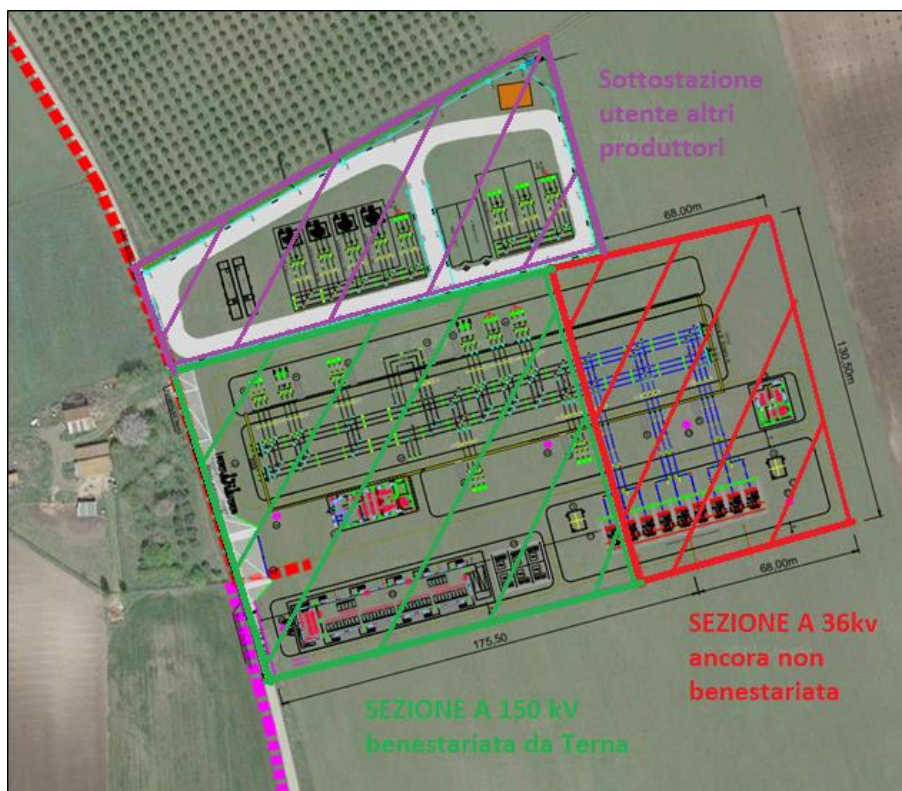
FIGURA – LAYOUT IMPIANTO “ALVIANO”
